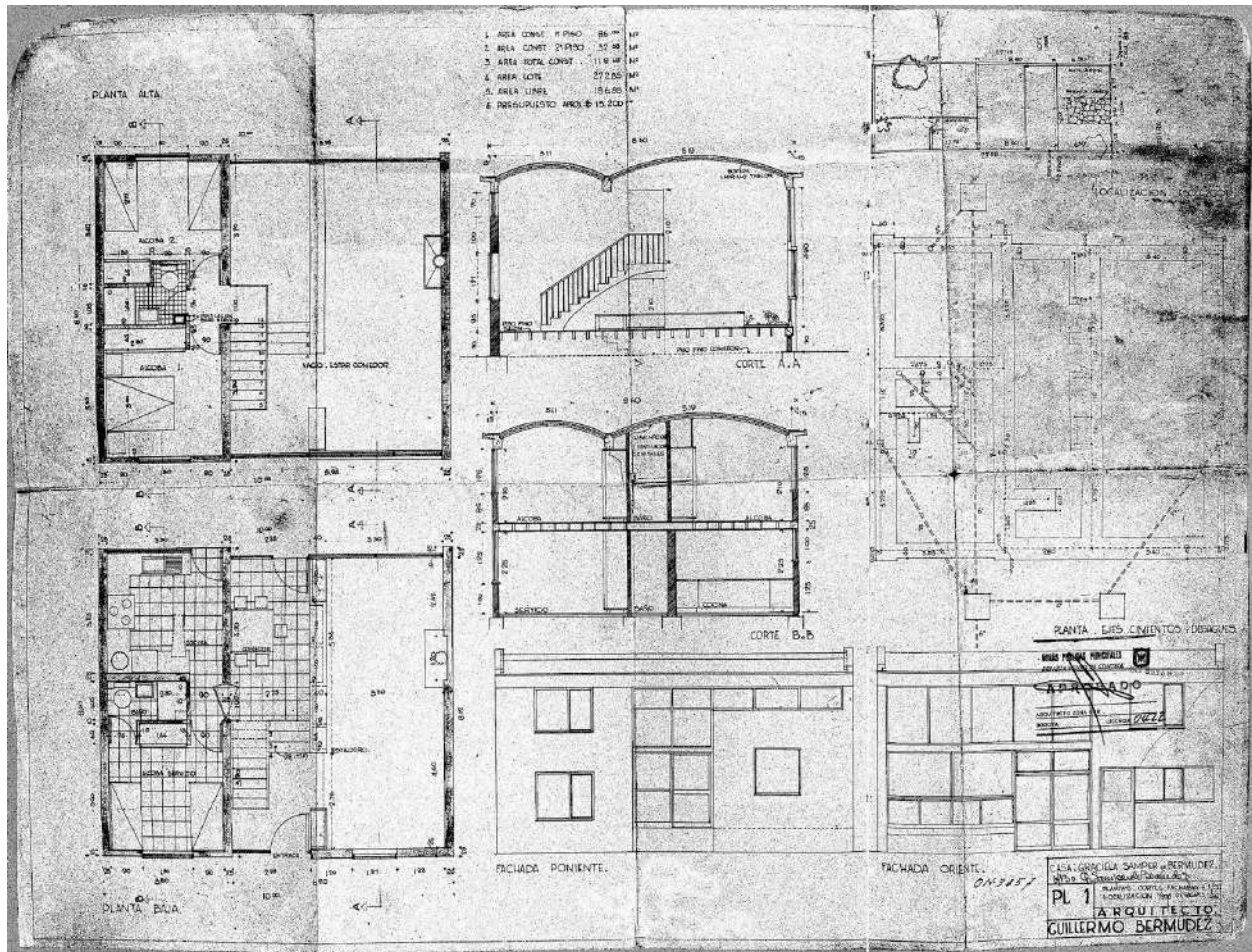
Plantas, cortes y fachadas, y localización de la Casa Bermúdez, proyecto inicial. Fuente: Samper, E. (2000).
